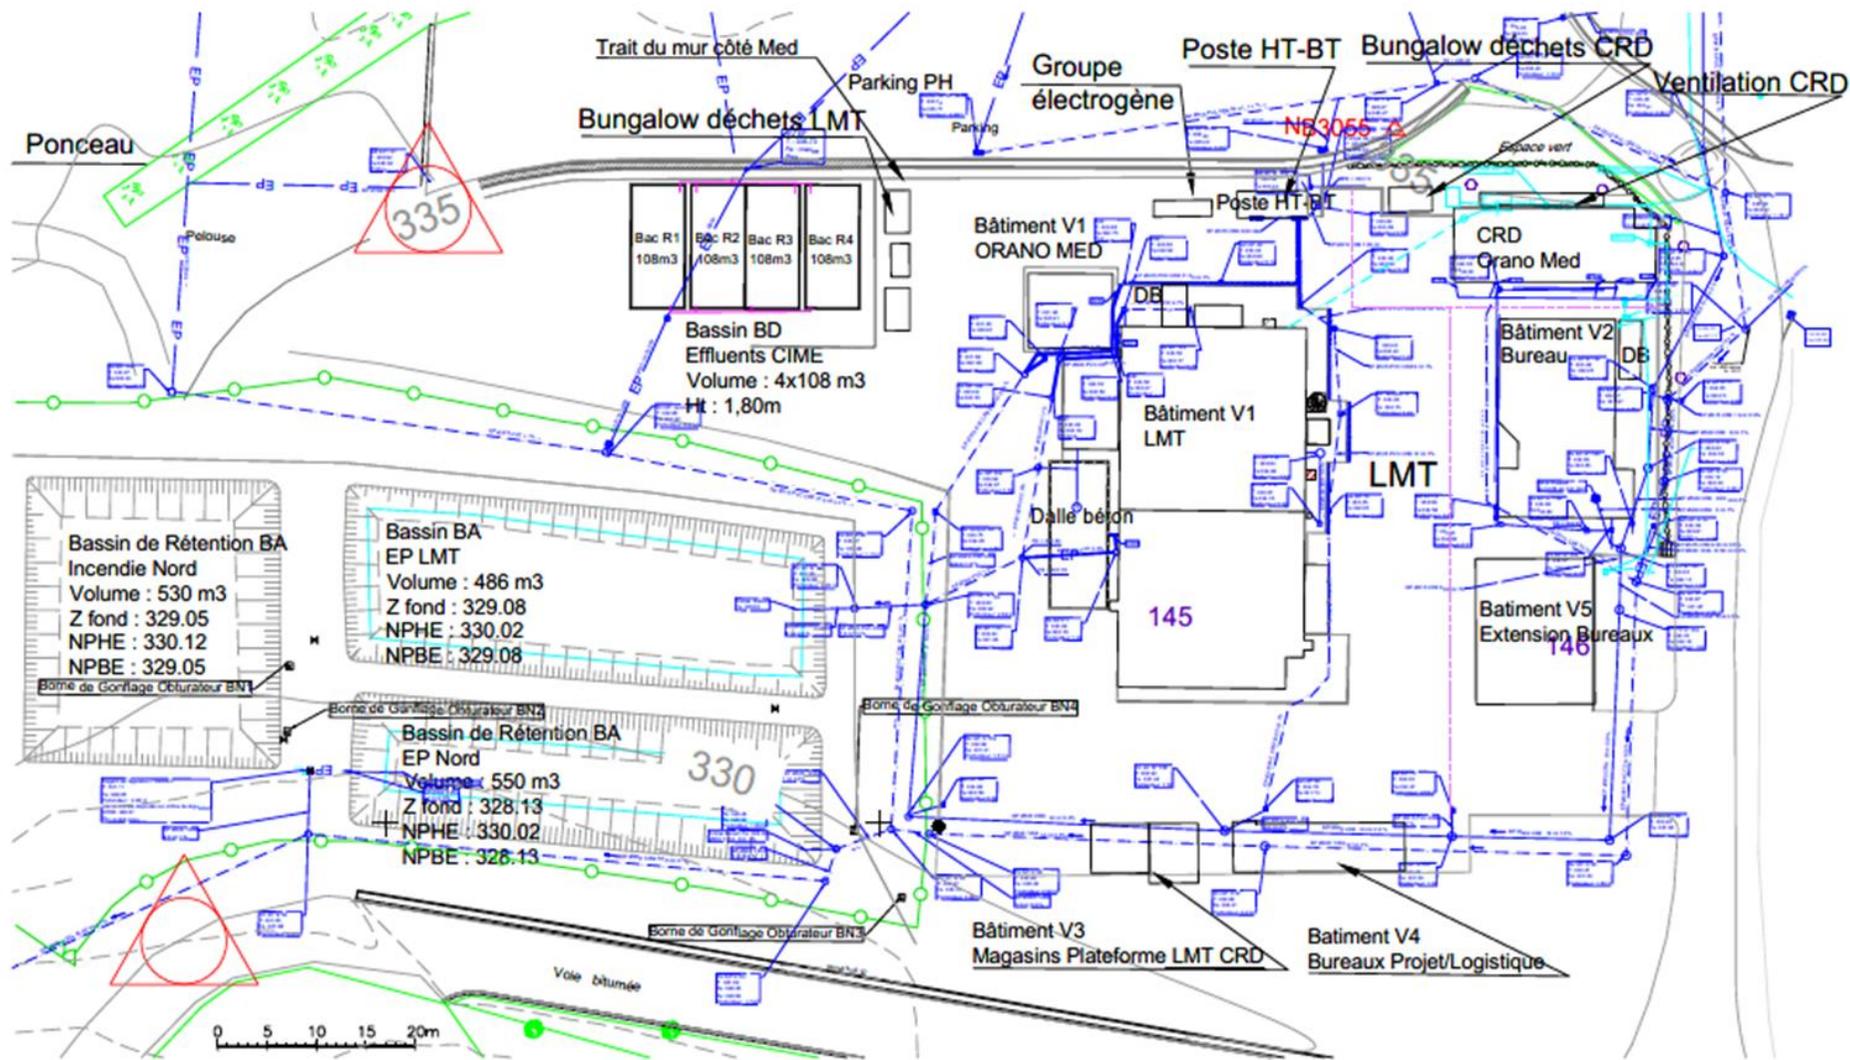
Plan du réseau des eaux pluviales provenant du LMT
